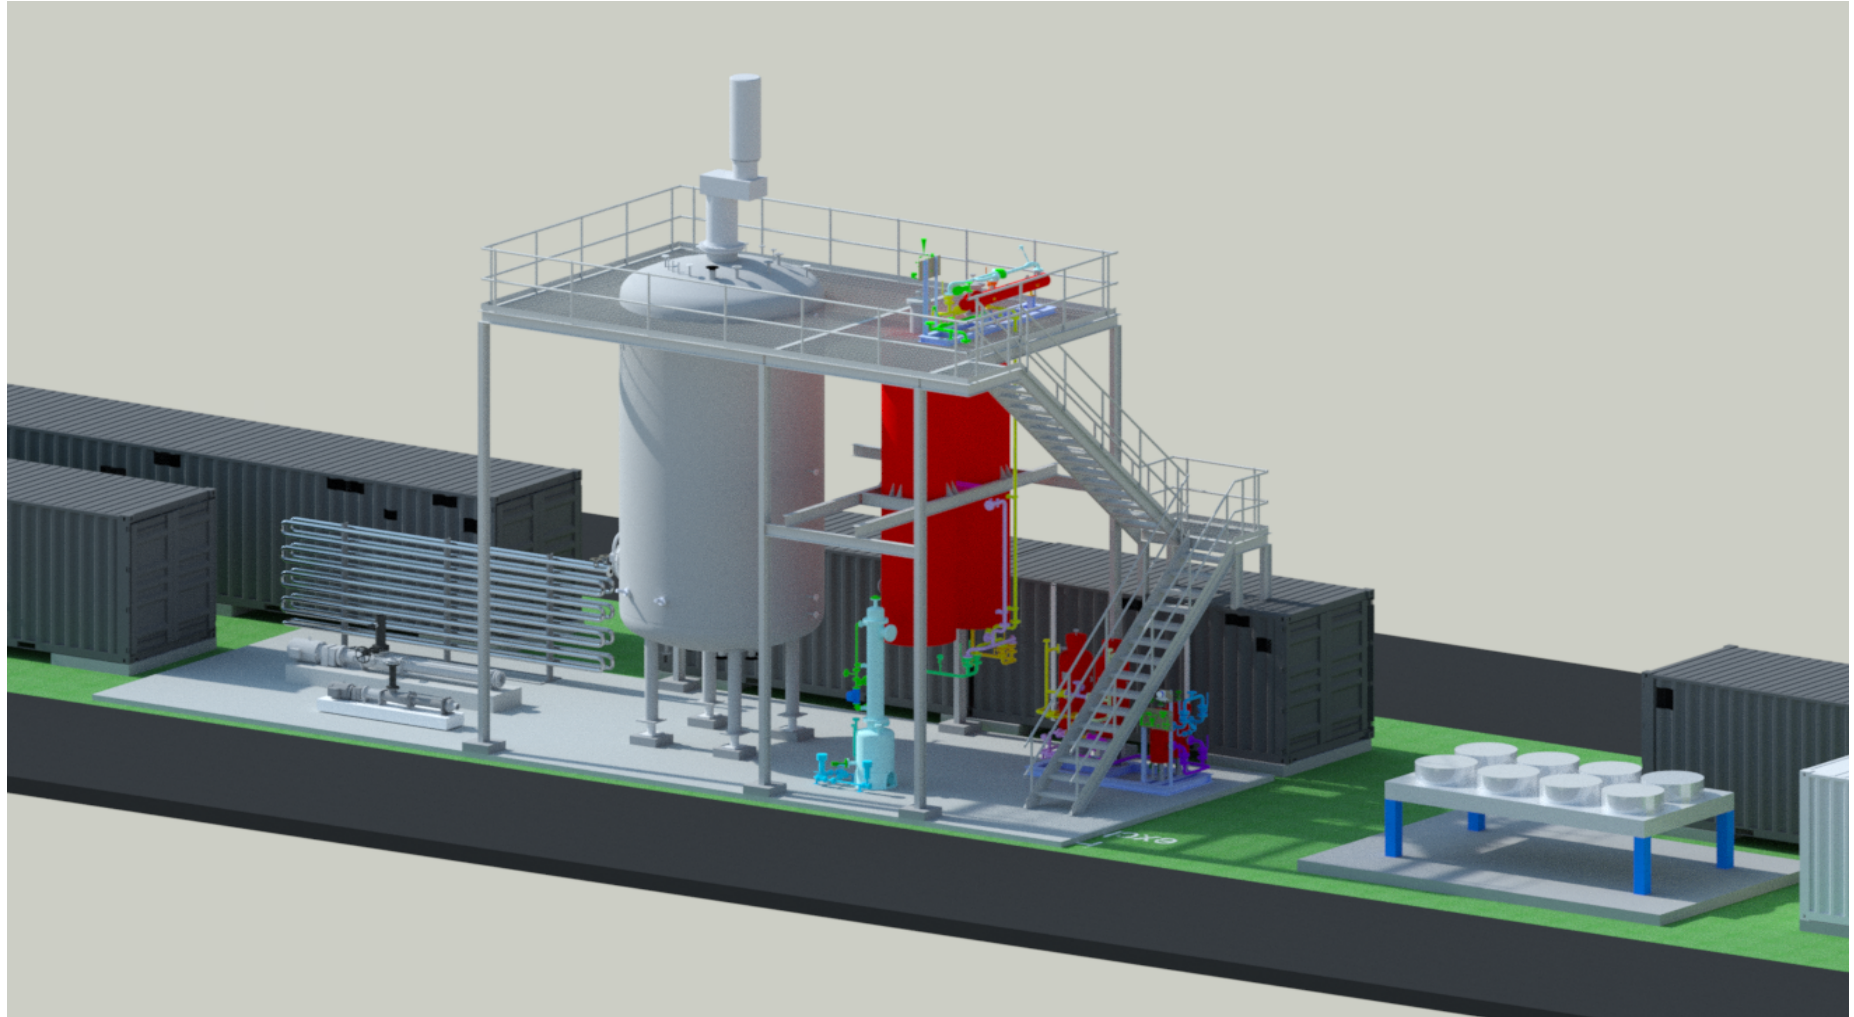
PLANT LAY-OUT ADDH2 ROUTE
